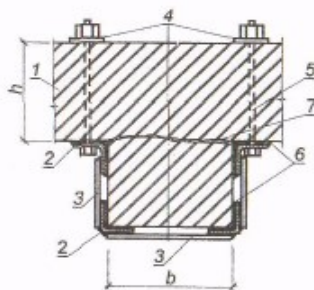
Усиление кирпичных пилястр: 1 - усиливаемая кирпичная стена с пилястрой; 2 - стальные уголки; 3 - соединительные планки (хомуты); 4 - упорная шайба $b = 10 \dots 12$ мм; 5 - болт диаметром 18..22 мм; 6 - зачеканка цементным раствором; 7 - трещина в месте сопряжения пилястры со стеной
